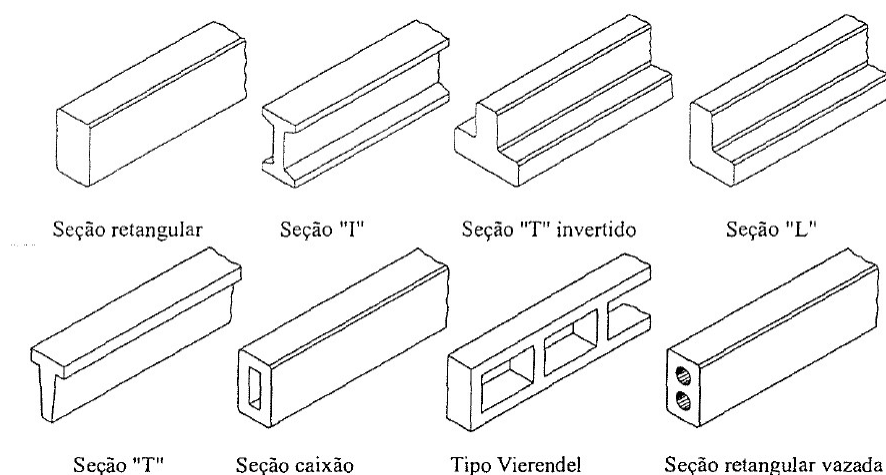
Tipos de vigas e suas seções transversais (El Debs, 2000)
